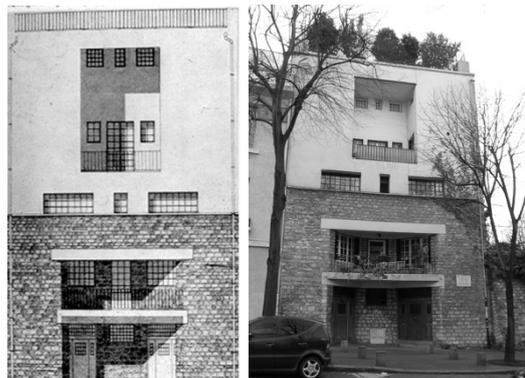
Fachada principal da Casa Tristan, 1926, Adolf Loos
